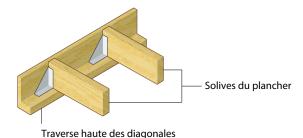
Exemple de pose des solives sur la traverse haute du niveau bas
